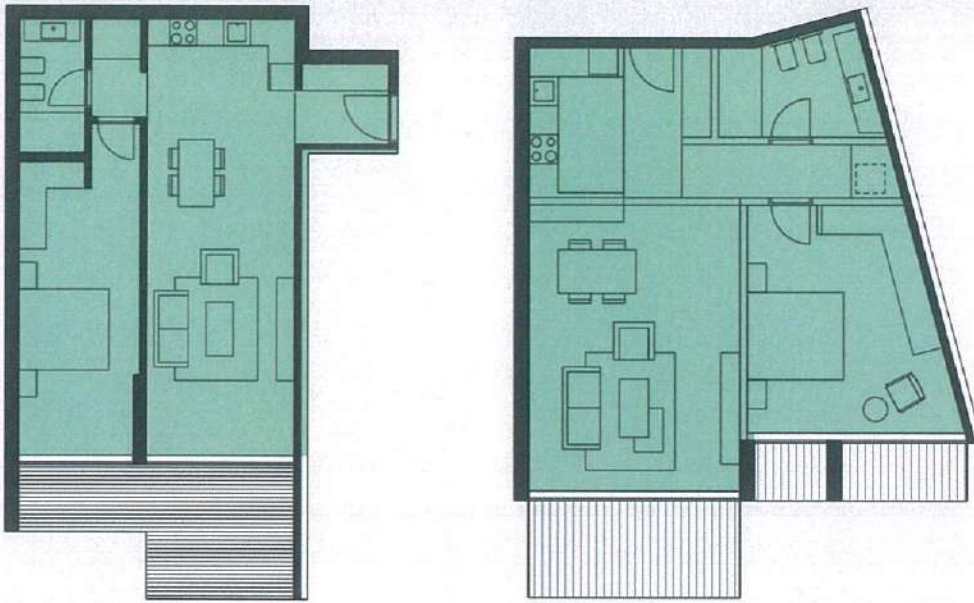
Planimetri e Apartamentit Tip 1+1 - Nënvariante
